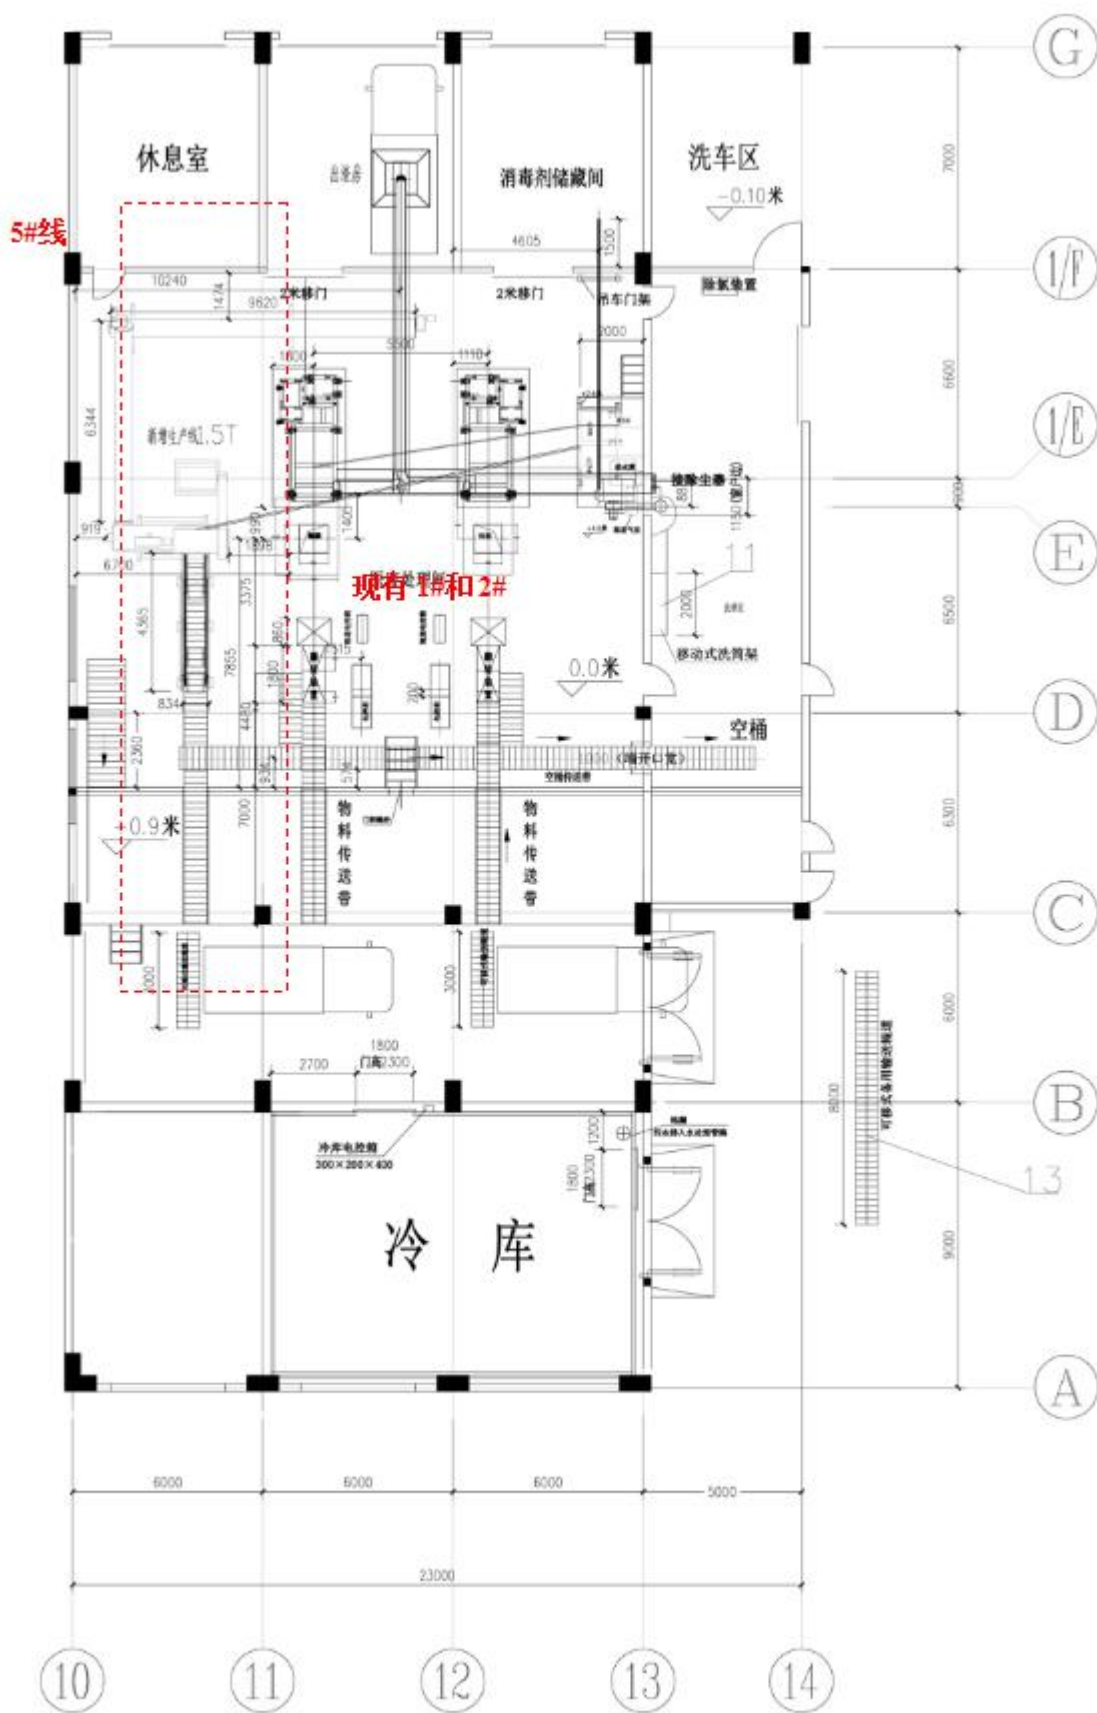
5#线所在车间（医疗处置 A 区）平面图-项目一期
